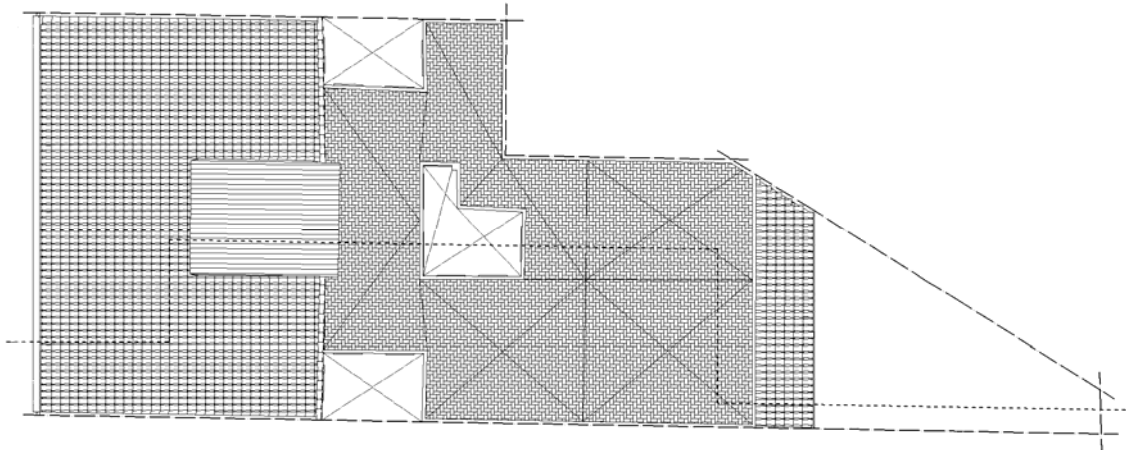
Cubiertas del edificio actual. Fuente propia.
